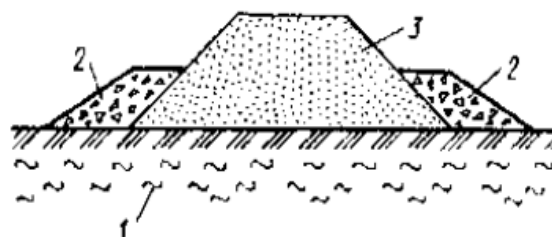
Усиление стабильности насыпи на мягких грунтах с помощью метода боковой пригрузки: 1 – слабый грунт; 2 – боковая пригрузка; 3 – насыпь.
